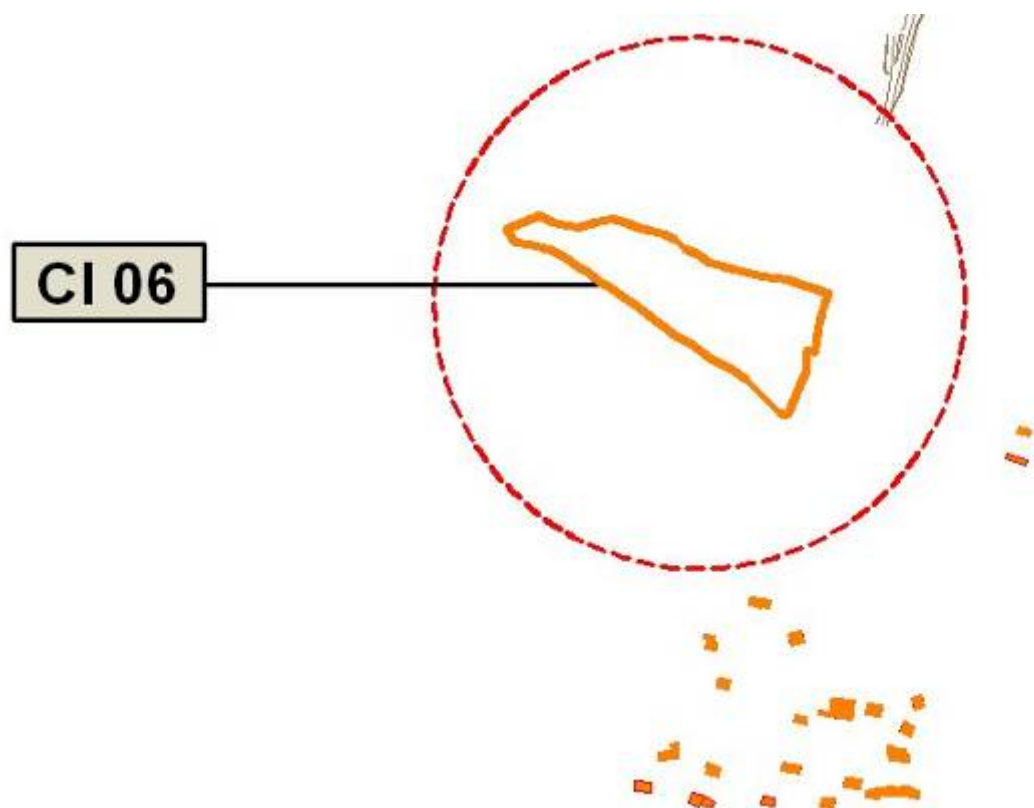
Area di cantiere CI06: ricettori compresi entro il raggio di 200 m
